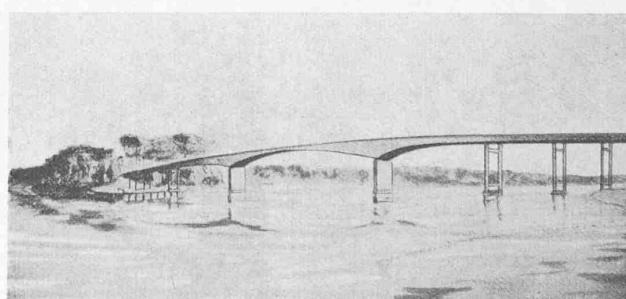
Sandö-Brücke. Ansicht der Eisenbeton-Balkenbrücke über den linken Flussarm. Stützweiten 40—70—40 m, Gesamtlänge 341 m, Betonmasse rd. 4000 m<sup>3</sup>, Stahlbewehrung rd. 500 t
